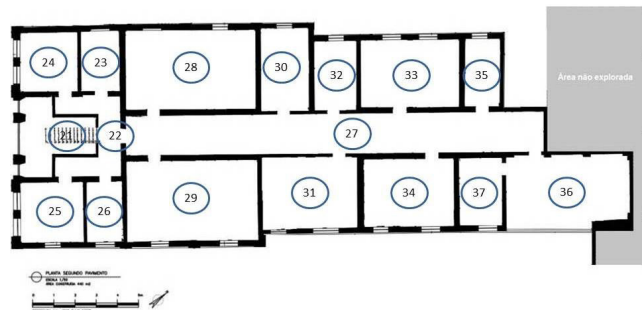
Planta baixa nº 2: segundo pavimento, momento anterior à implantação do HNPI. Fonte: Adaptação de planta baixa cedida pela Oficina de Arquitetura e Restauro do Espaço Comum Luiz Estrela. Brandão, 2015.
